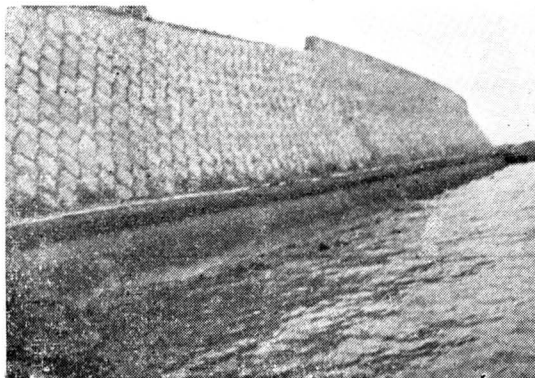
鍋田干拓堤防測点 No. 83 付近の破壊状況
